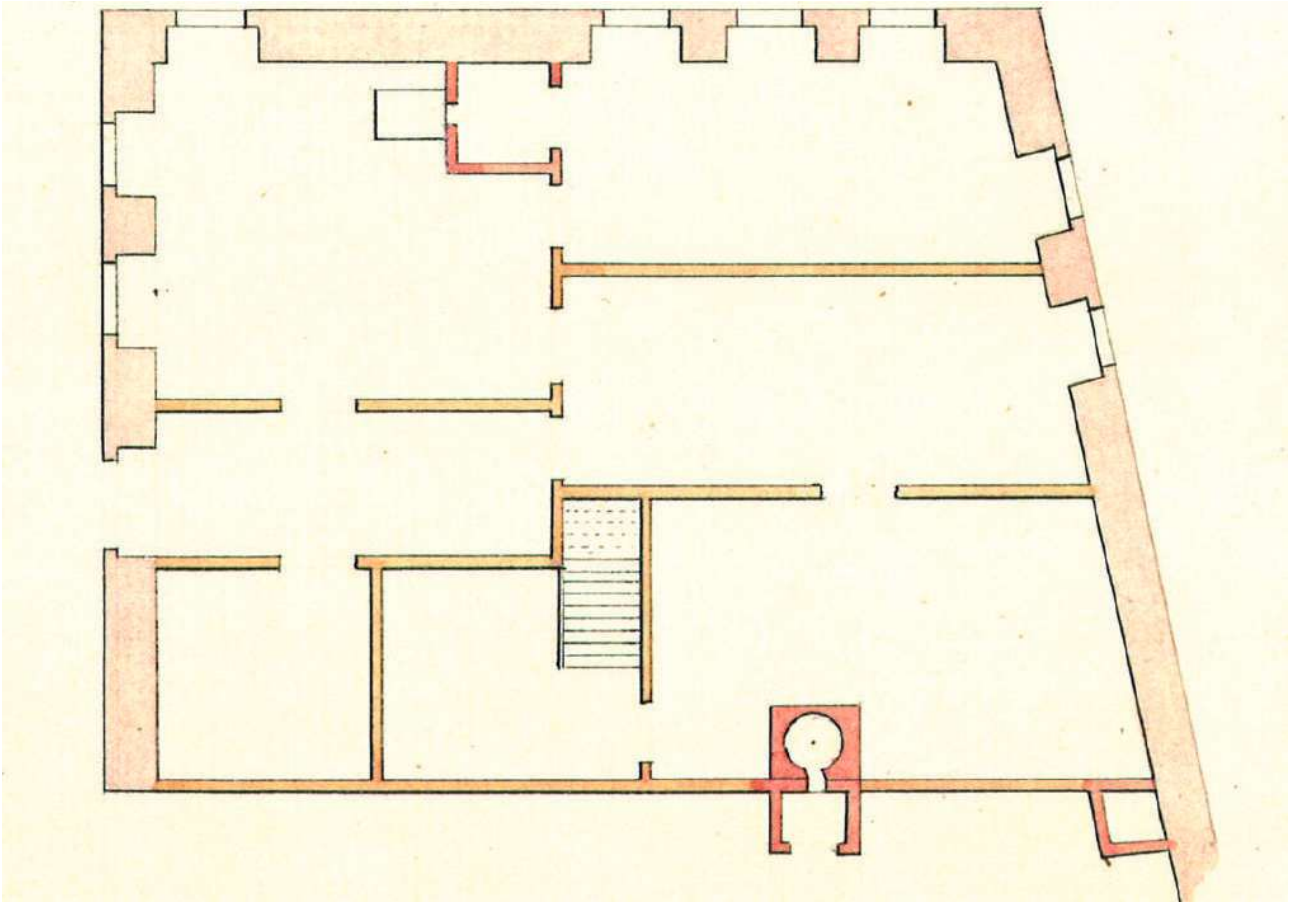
Bestandsplan des abgegangenen Kaplaneihauses, Erdgeschoss, um 1820
